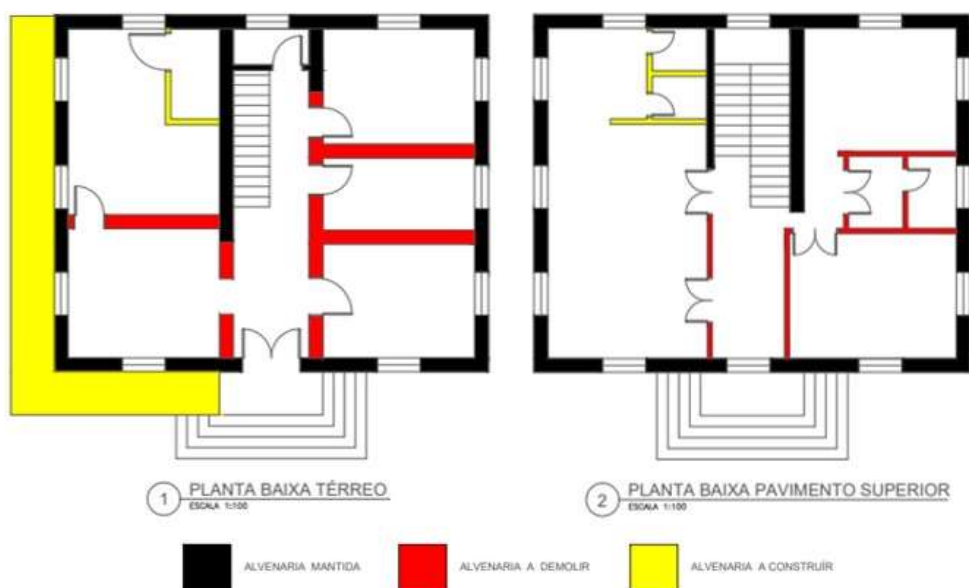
Projeto arquitetônico: Planta de Demolição e Construção
